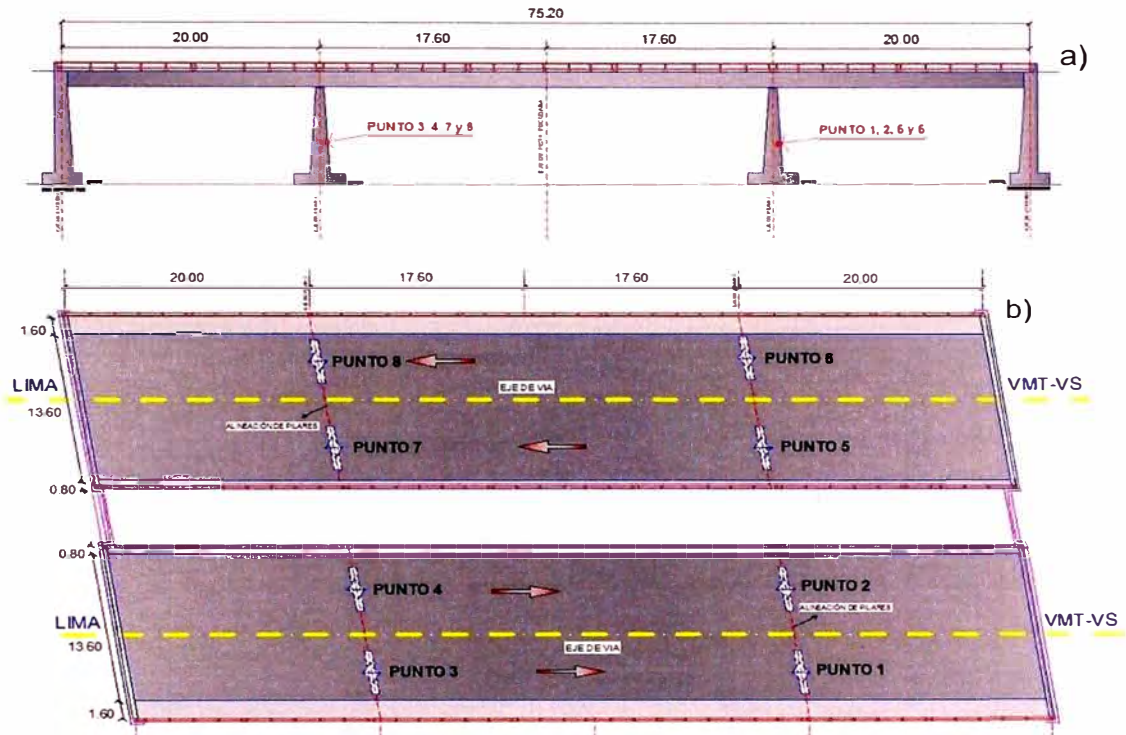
Ubicación de los ensayos con esclerómetro a) Elevación y b) Vista en planta del puente Atocongo
